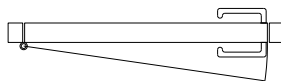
Detalle en planta de puerta batiente peatonal de 1 hoja.
